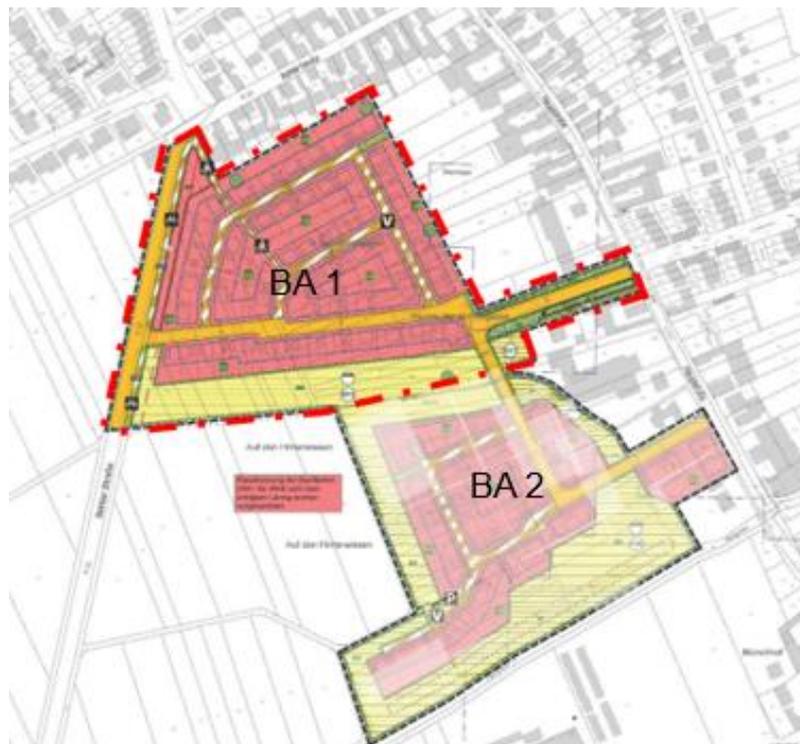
Ausschnitt aus dem Bebauungsplan Wohngebiet „Hauptstraße - Böhler Straße“ in Dannstadt-Schauernheim Bebauungsabschnitte 1 und 2, Stand September 2020 (veränderte Darstellung)
